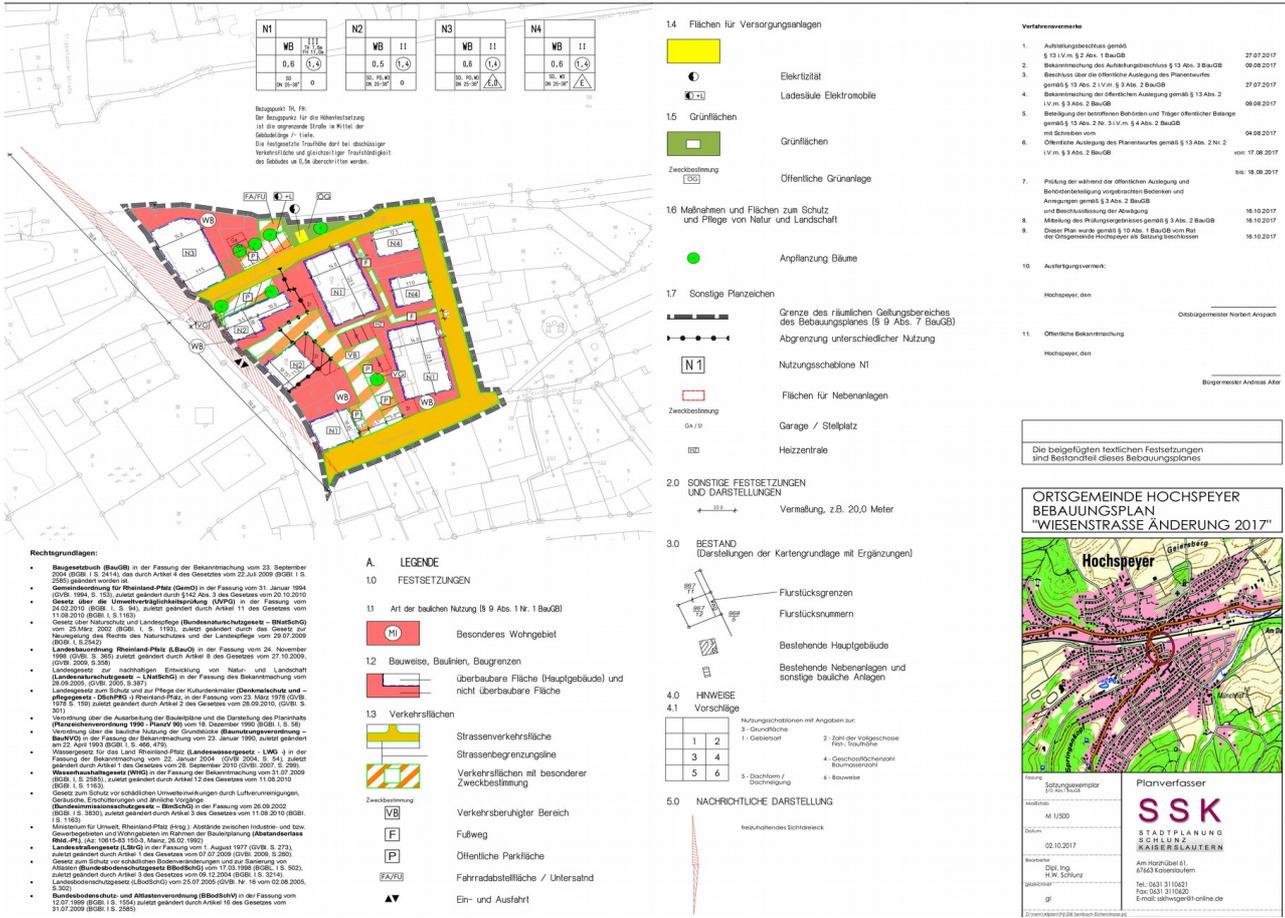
Bebauungsplan „Wiesenstraße“ Änderung 2017
